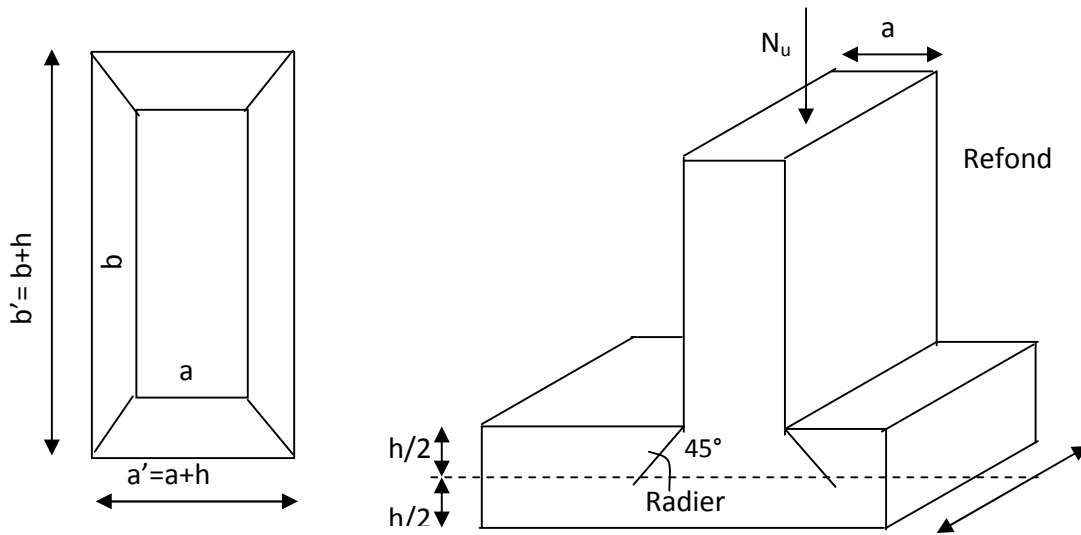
Périmètre utile des voiles et des poteaux. b
